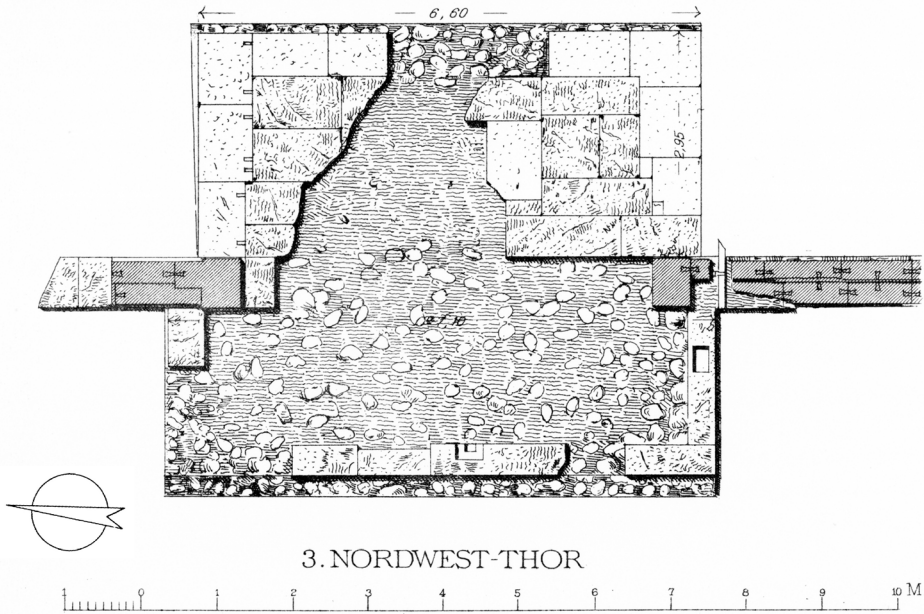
Steinplan des Nordwesttors (M. 1 : 100)
